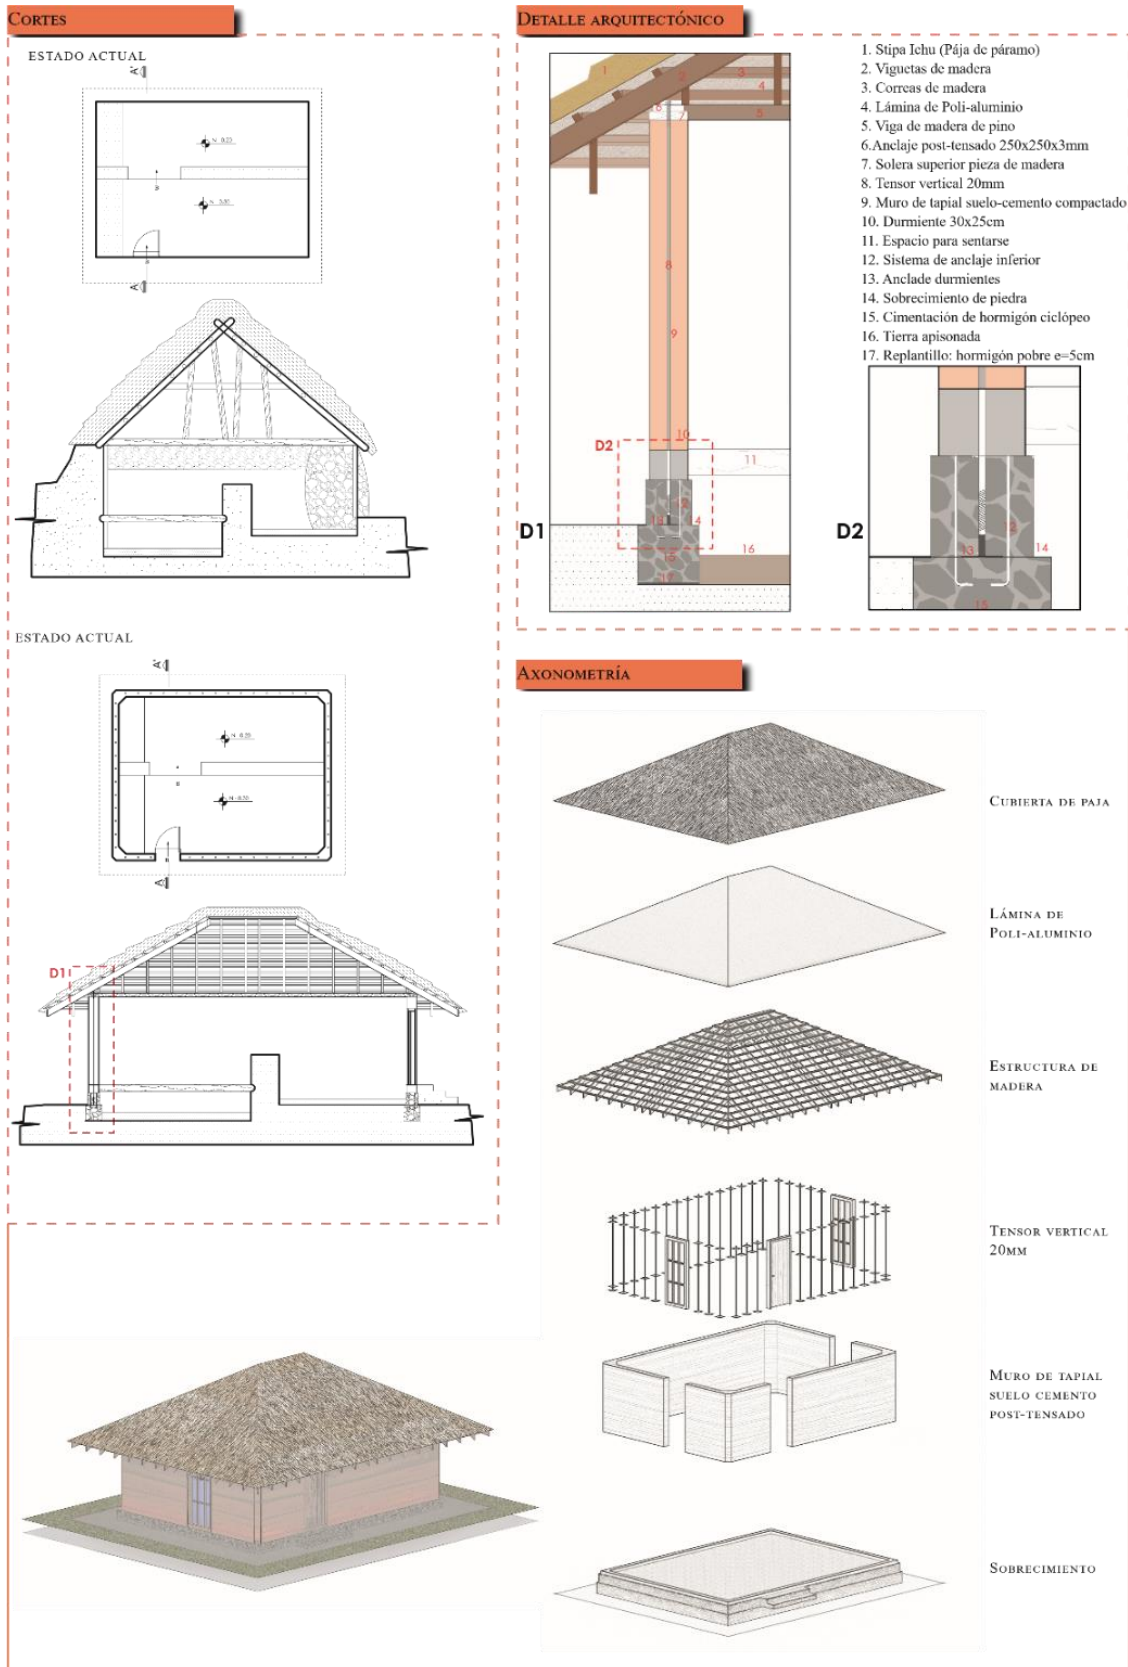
Planos estado actual y propuesta. Fuente: Pastuña & Vallejo, 2022
